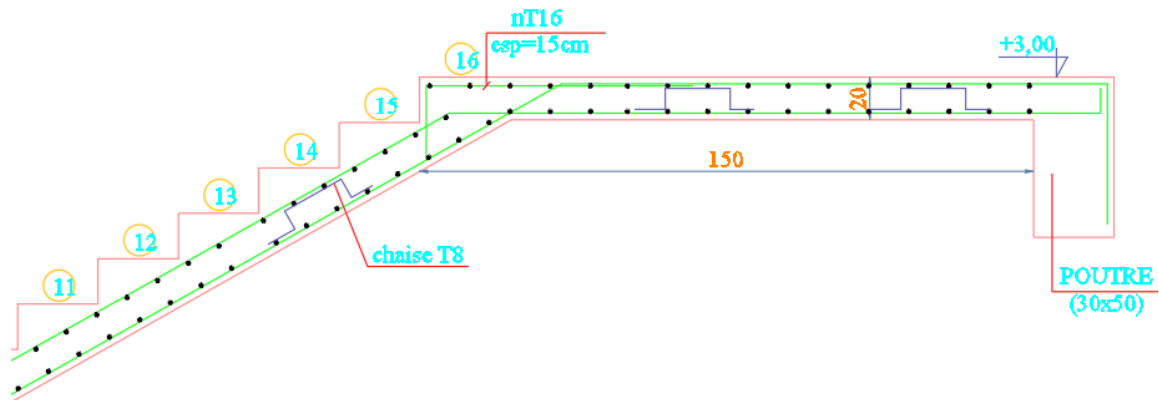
Schéma du ferrailage des escaliers partie supérieur
